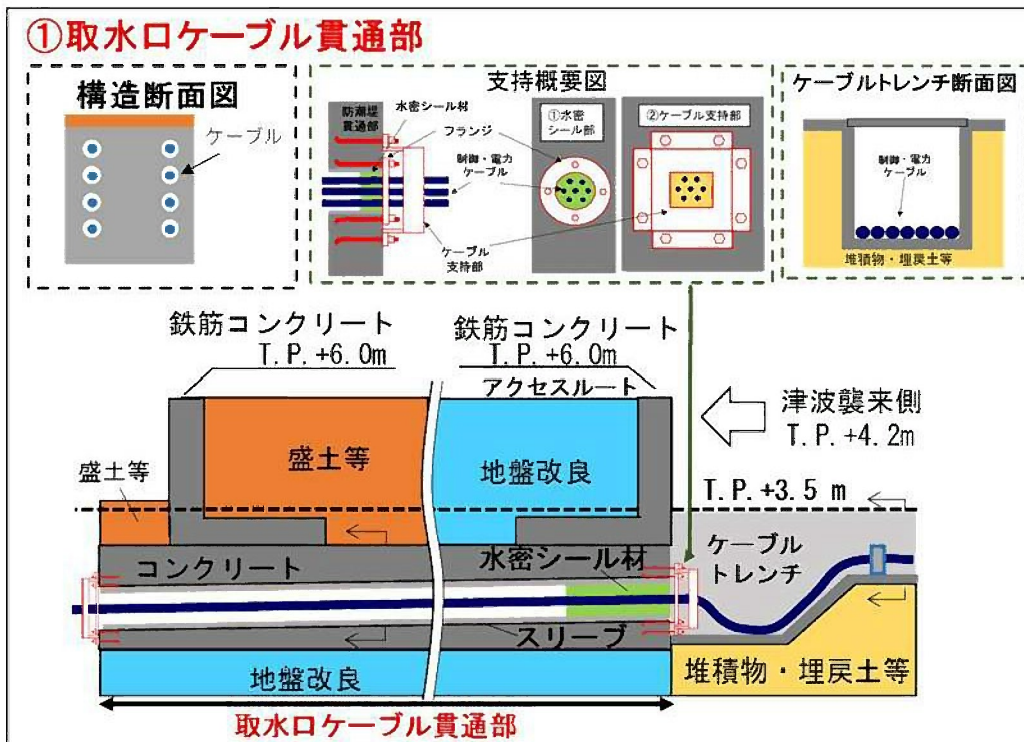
防潮堤貫通部止水処置部の構造概要図 (1/3)
